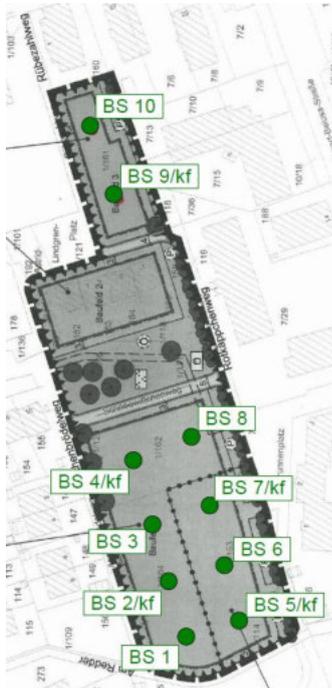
Baugrunduntersuchung mit Bohrpunkten
